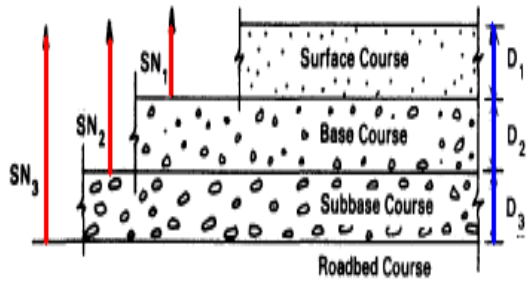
Estructura del pavimento (Fuente: Guide for design of pavement structures. AASHTO 1993)
